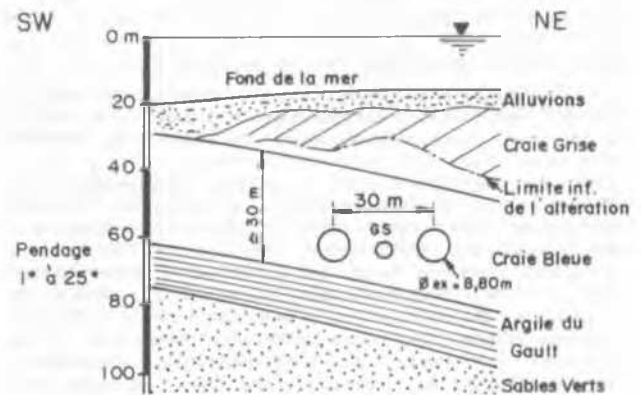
Coupe transversale typique du Tunnel sous la Manche (GS = Galerie de service)
